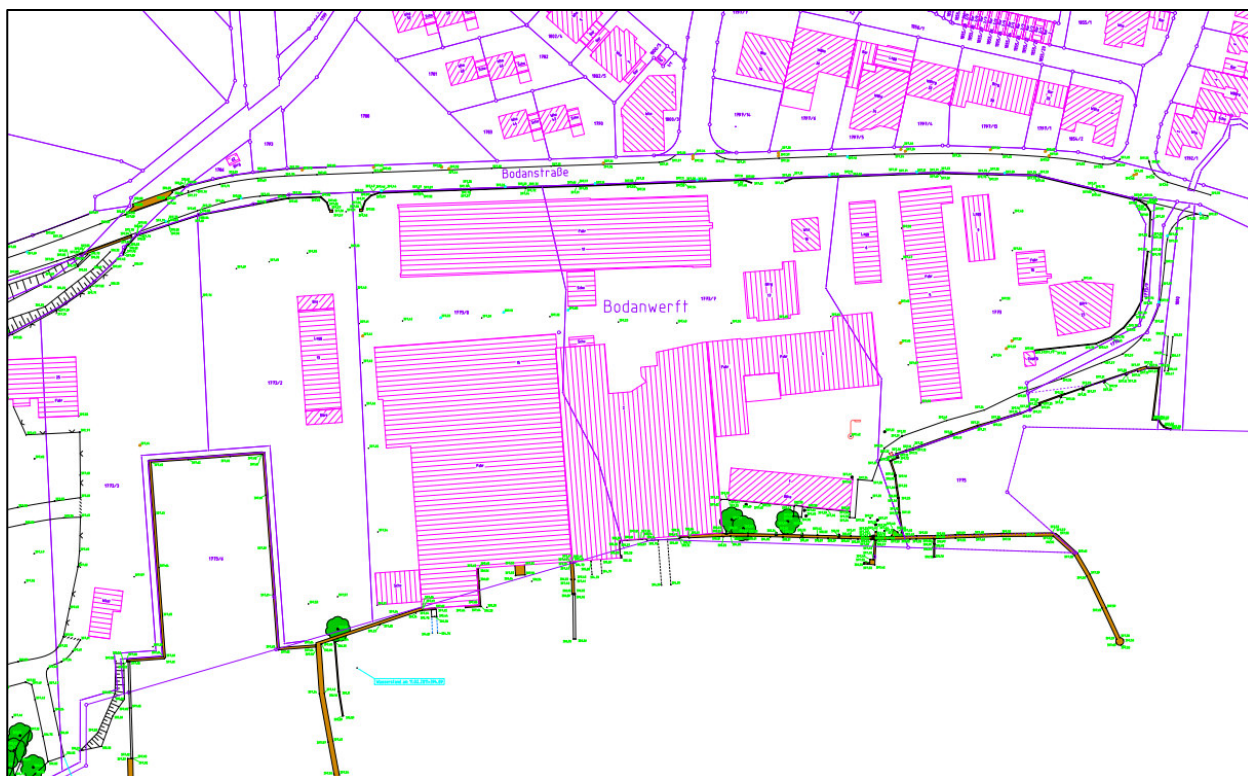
Lageplan der Bestandsvermessung der Mauer im Bereich Bodanstraße (Quelle: Vermessung durch Ingenieurbüro Meixner Infrastruktur GmbH)
